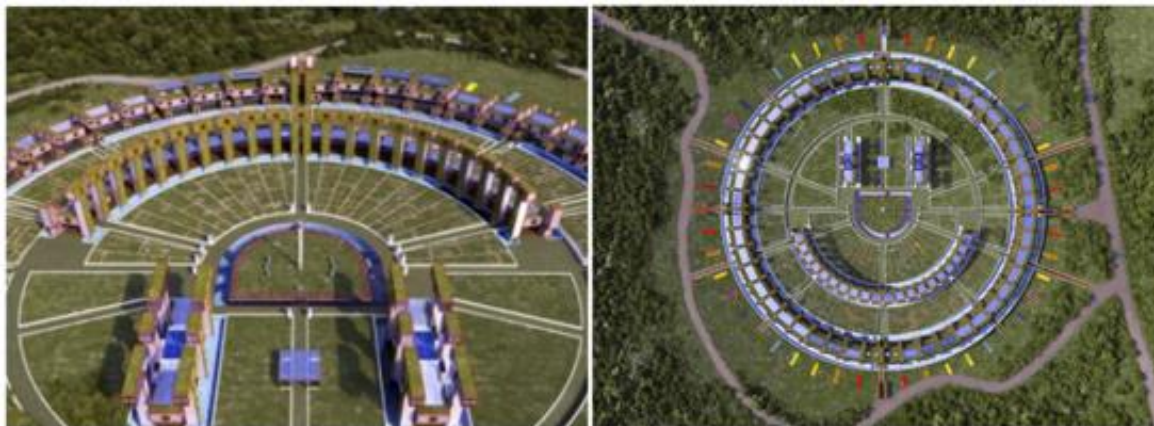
Render del conjunto y planta arquitectónica. Garrido (2015)
